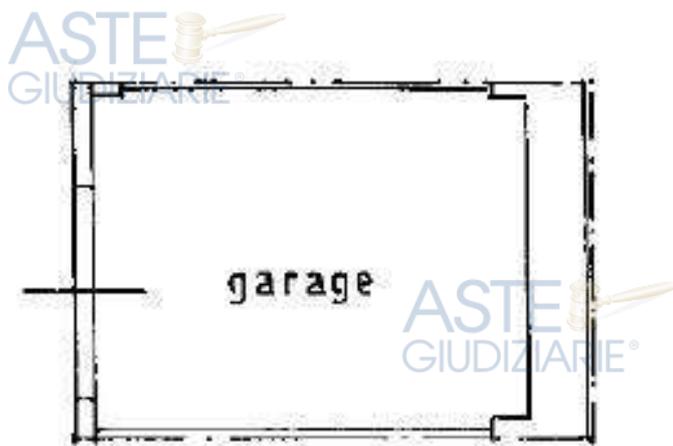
Planimetria Catastale garage Via Pirandello, 26 – Misterbianco
